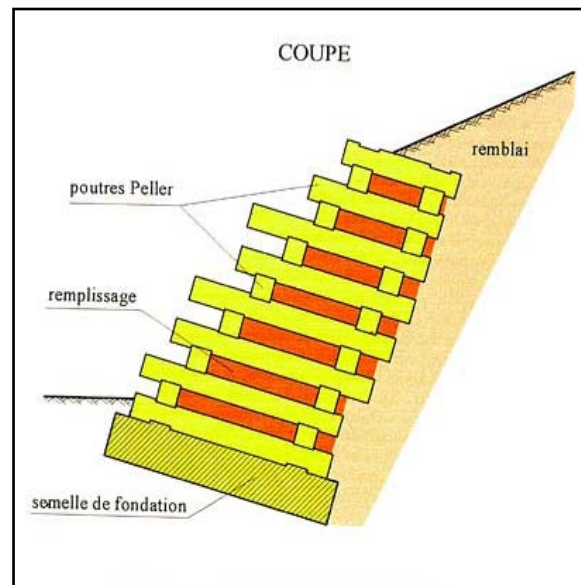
Mur en éléments préfabriqués en béton empilés (PELLER).
